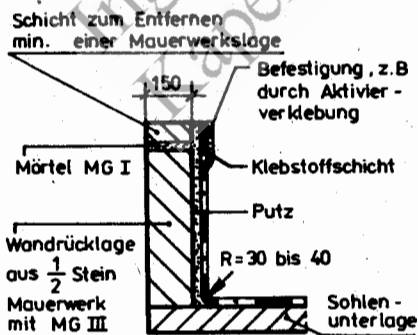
Innerer Dichtungseinbau mit vertikaler Halterung
